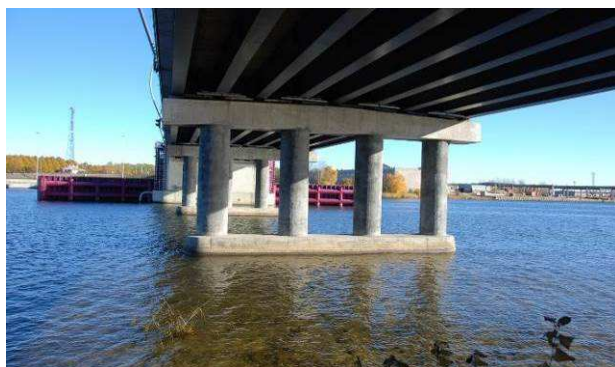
att. Plaisas un kavernas balsta Nr. 7 režģogā. Torkretētās betona kārtas atslāņošanās.
